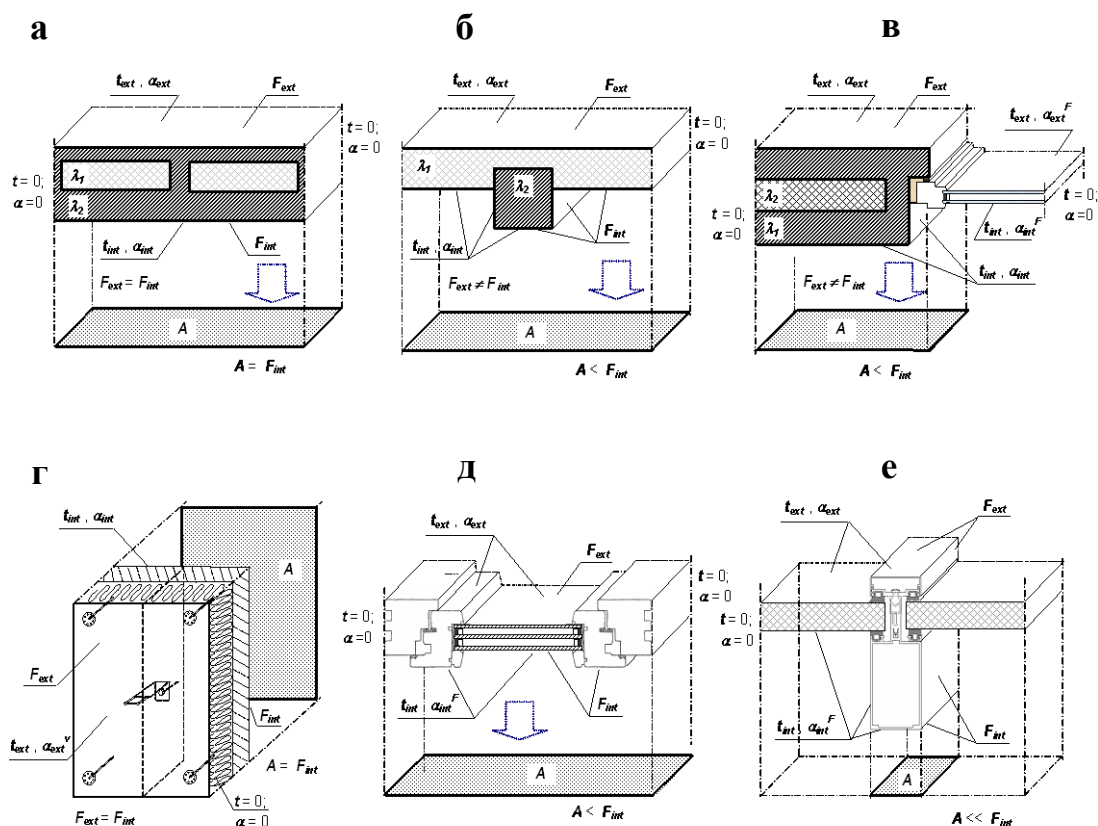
Примеры задания граничных условий и определения площадей приведения A_i для расчета приведенного сопротивления теплопередаче некоторых конструкций: а, б – фрагмента наружной стены с теплопроводными включениями без проемов; в – фрагмента наружной стены с оконным блоком; г – фрагмента наружной стены с фасадной изоляцией; д – оконного блока; е – системы профилей
